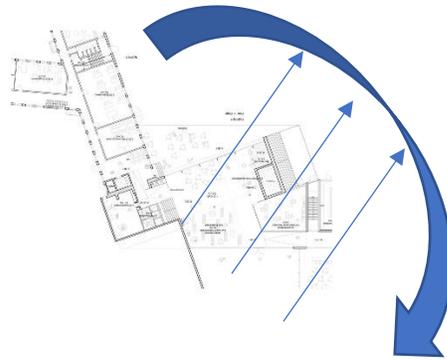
Planta Arquitectónica Centro Cultural Mariehøj
